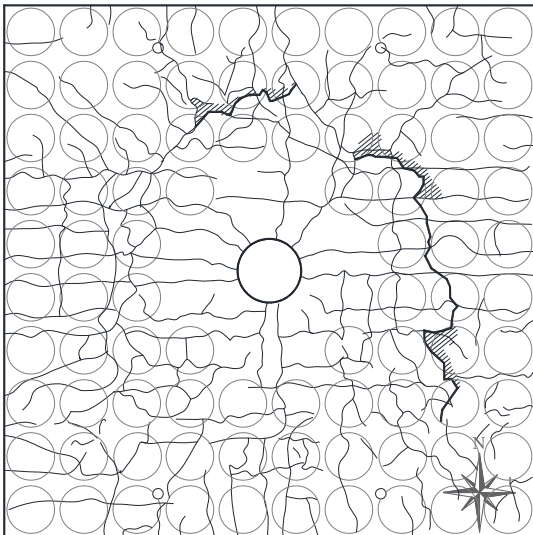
Mapa de fissuração da laje BD28P1
